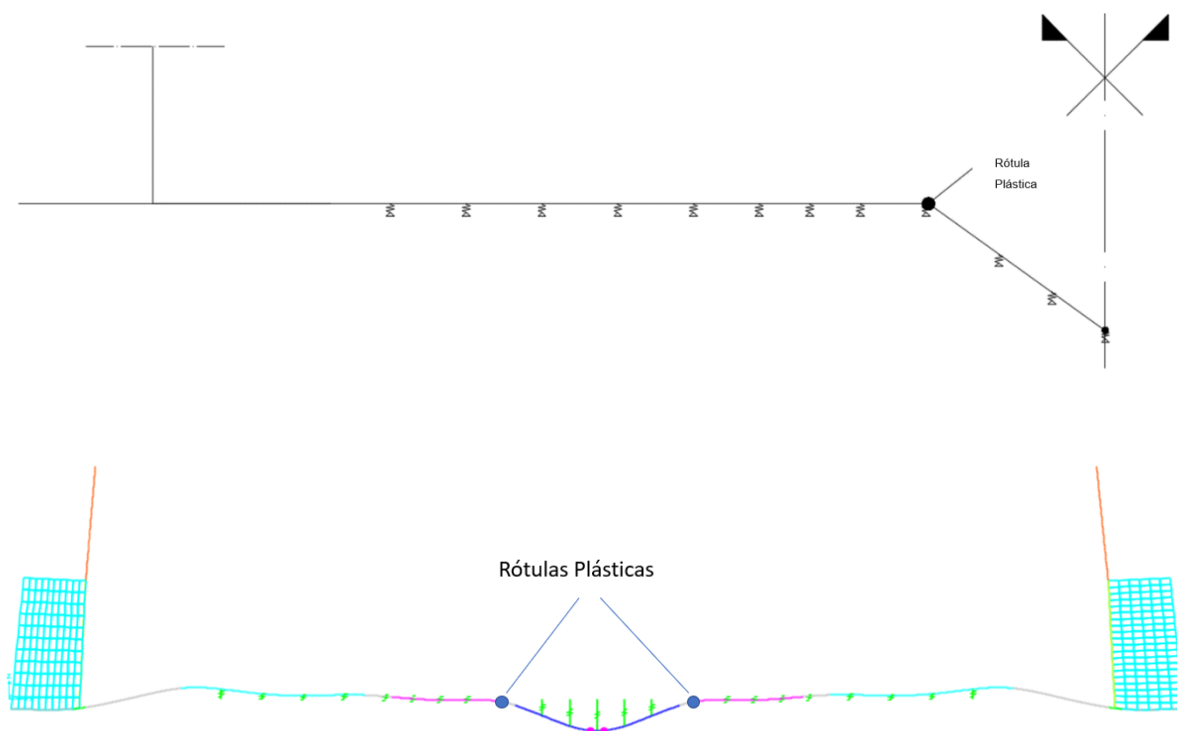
Ilustração da rotura parcial da laje após de atingir a carga máxima.
